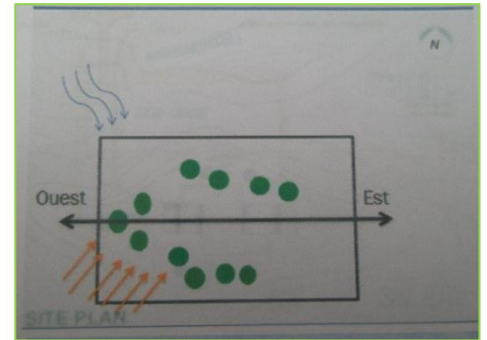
Plan de masse, Source: Steel, James 1997.An Architecture for people
